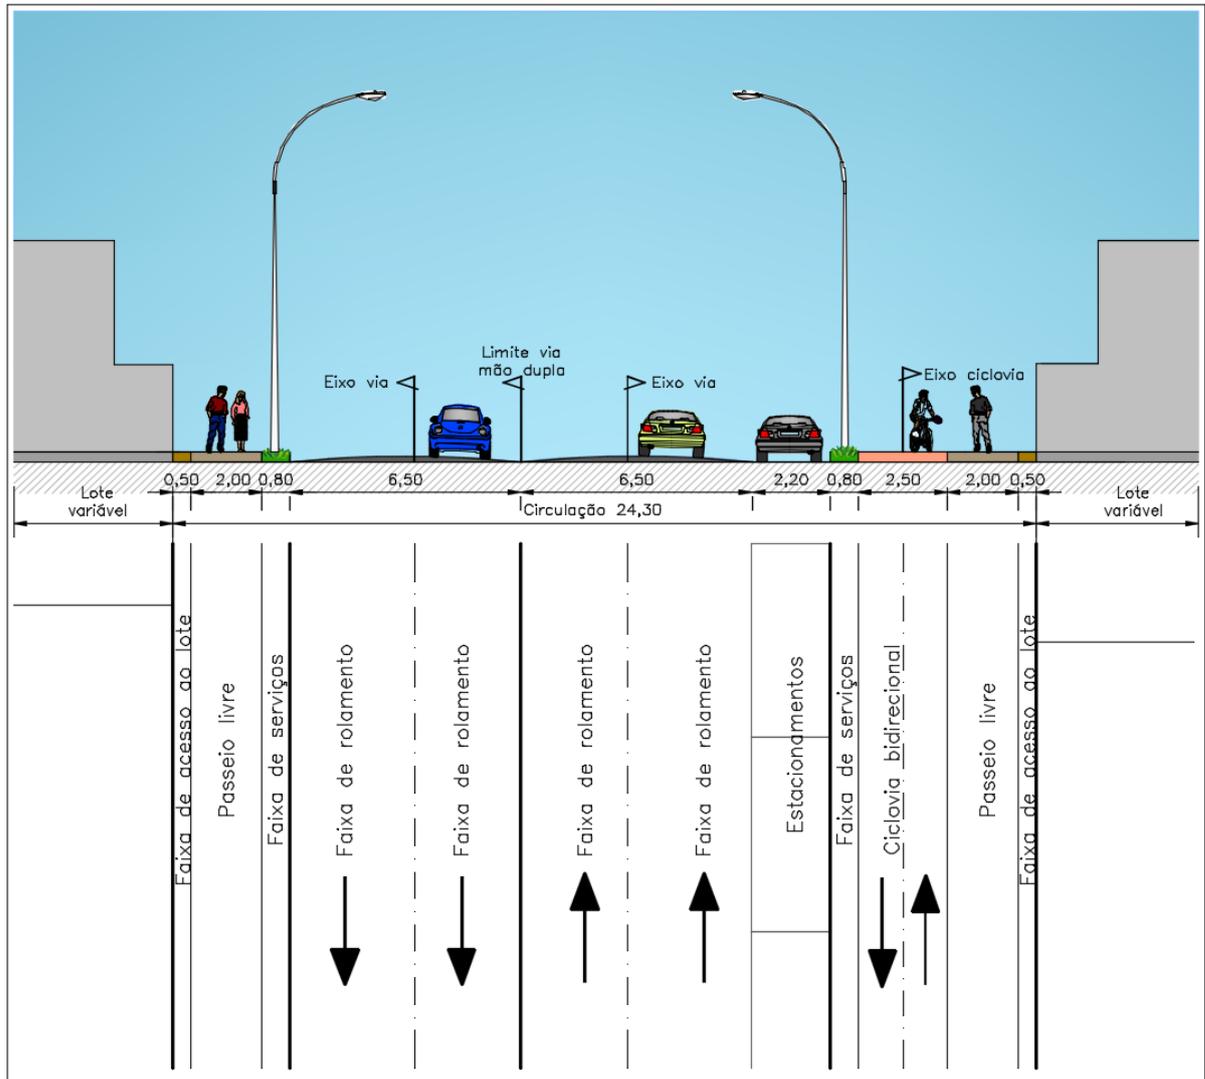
Perfil 02 - Via de Circulação (eixo leste-oeste)
